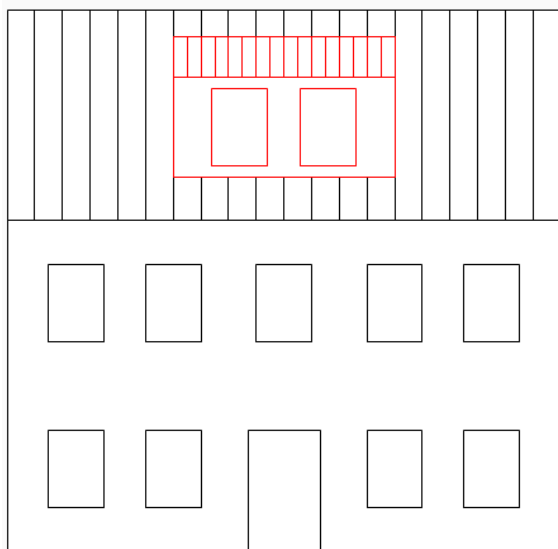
Dachgaube, zulässig gemäß § 5 Abs. 1-5
